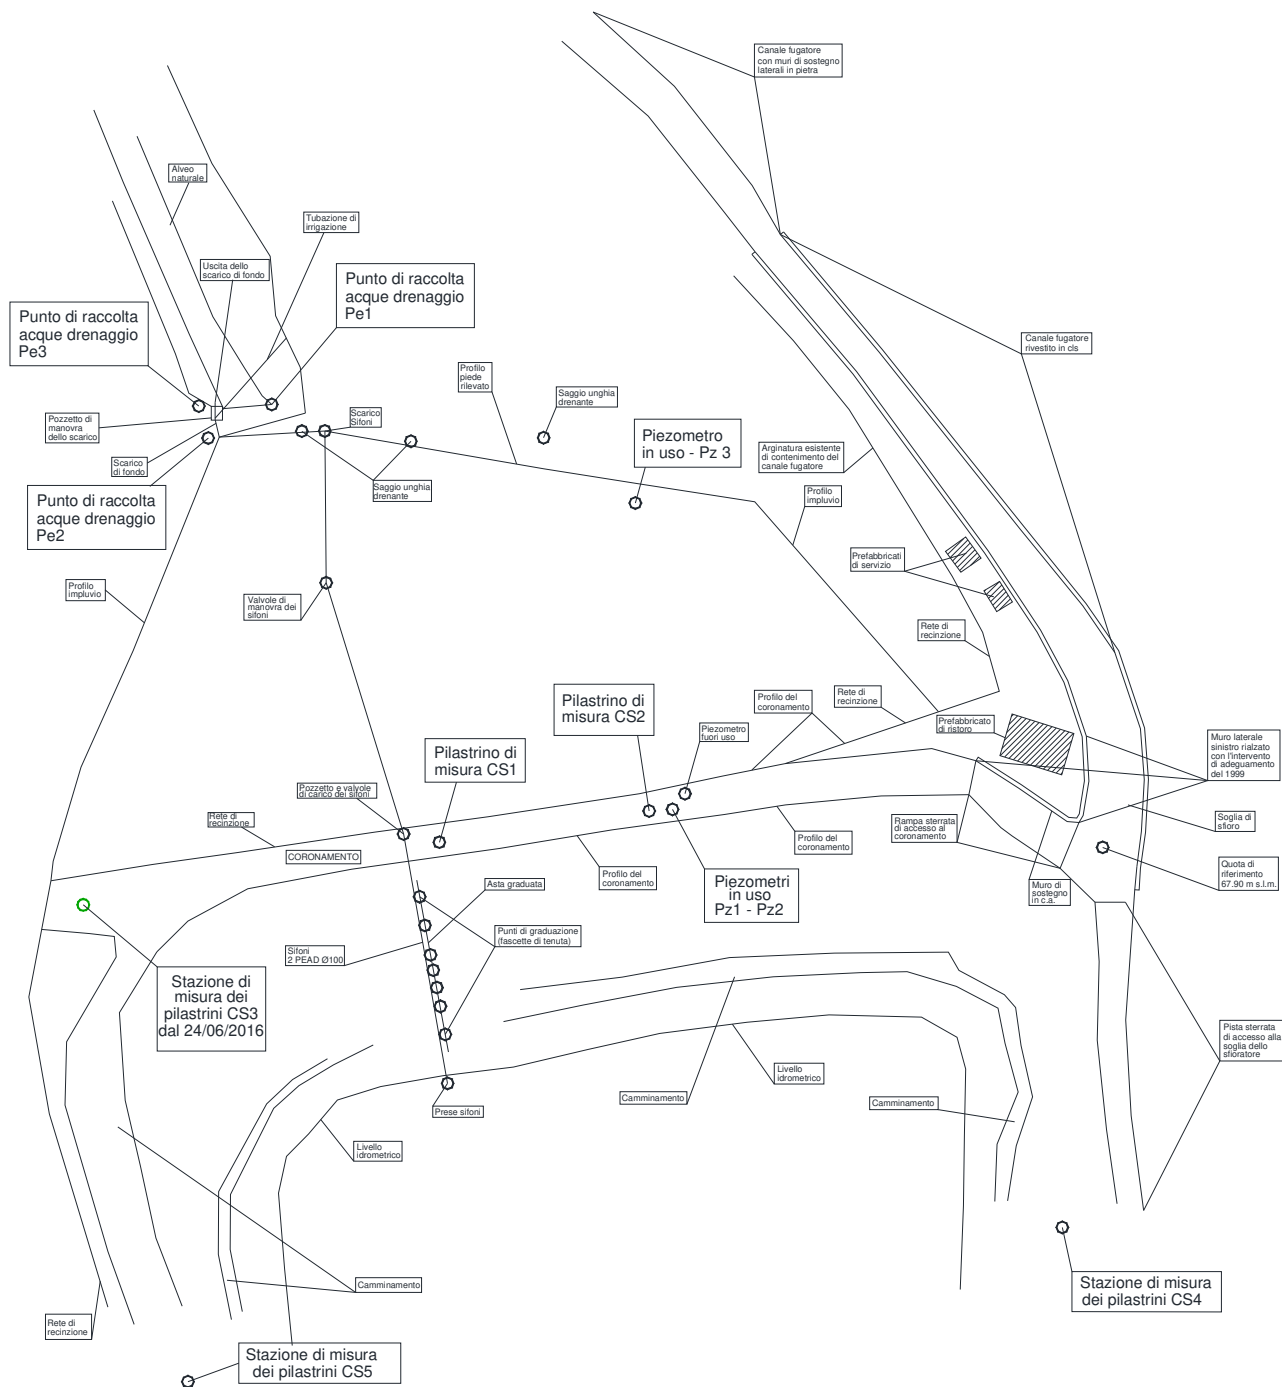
Schema planimetrico della diga di Sammontana nello stato attuale.
